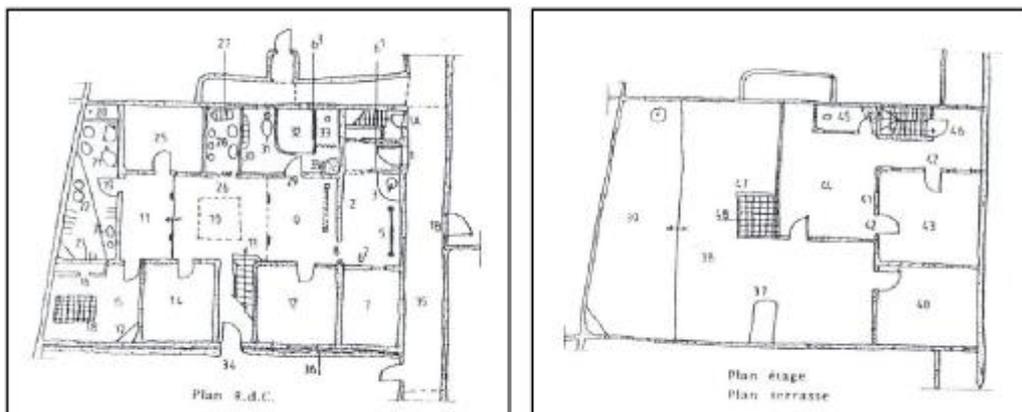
Plans d'une maison traditionnelle Ouarglie
